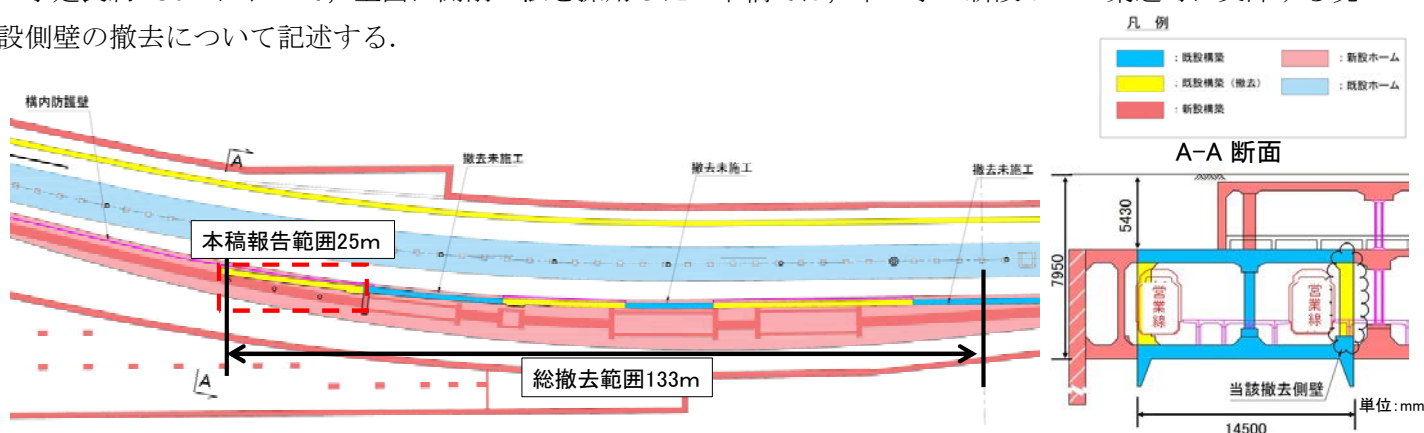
南砂町駅改良工事全体平面図及び側壁撤去範囲断面図
